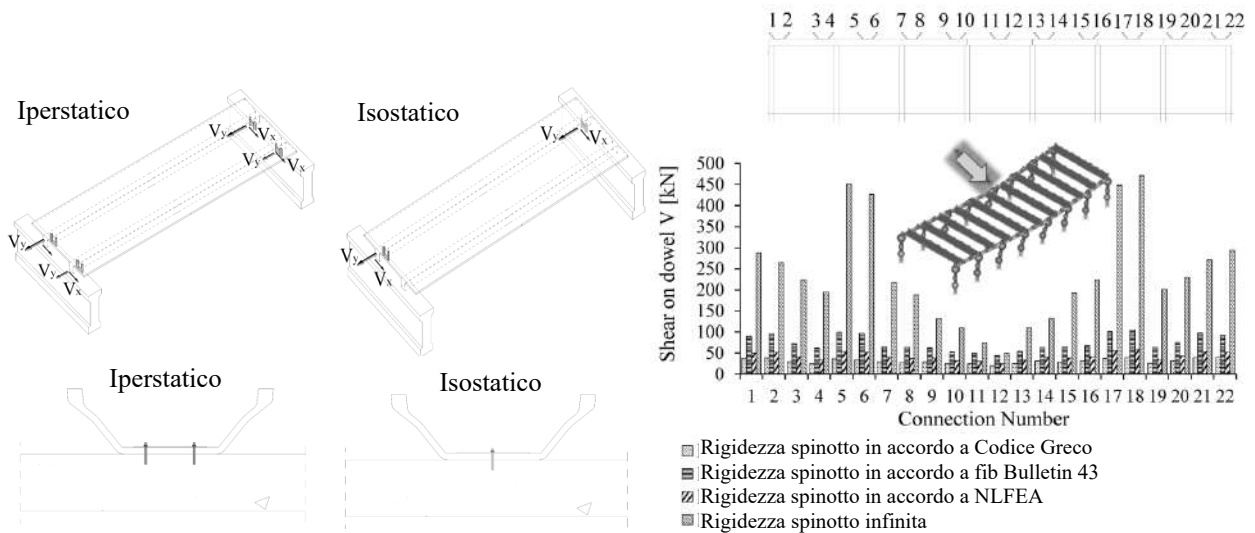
Schema statico del collegamento trave-tegolo (Belletti et al., 2014)
